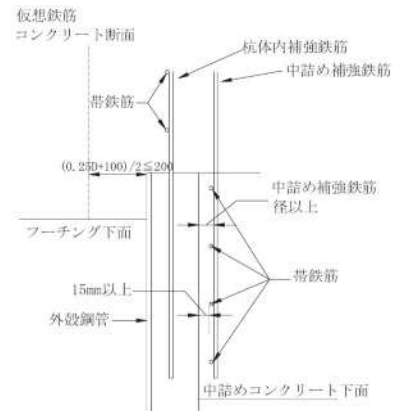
SC 杭の標準的な接合方法の構造詳細 (便覧図-Ⅲ. 5. 42)
